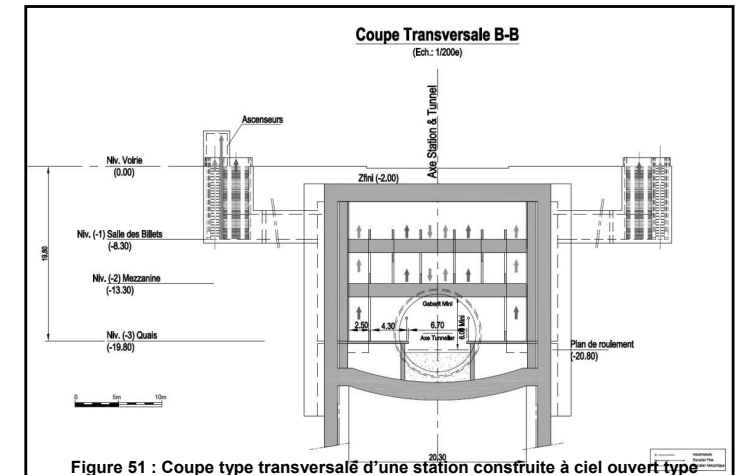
Coupe type transversale d'une station construite à ciel ouvert type
